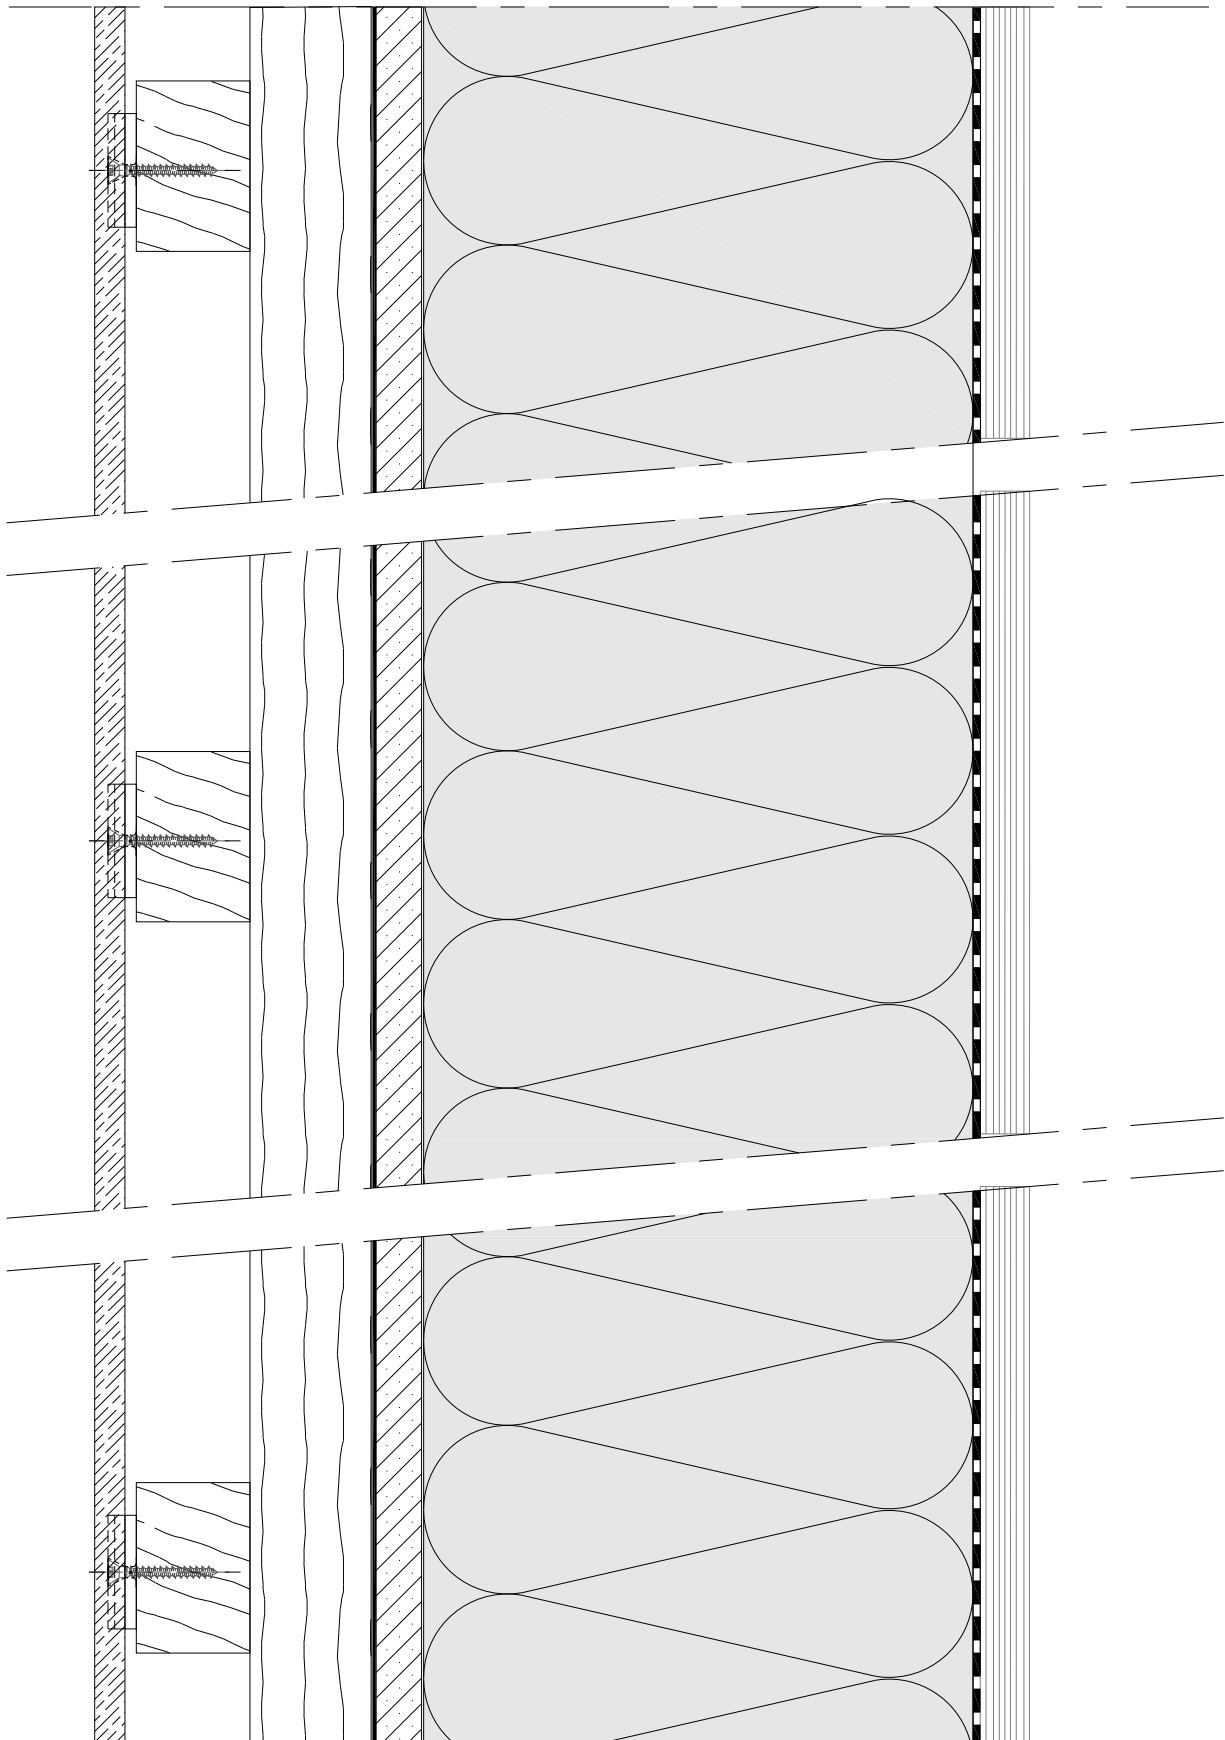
Pose verticale - Coupe horizontale sur COB/CLT
